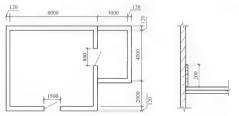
基房屋(楼)地面平面图及踢脚线示意图
